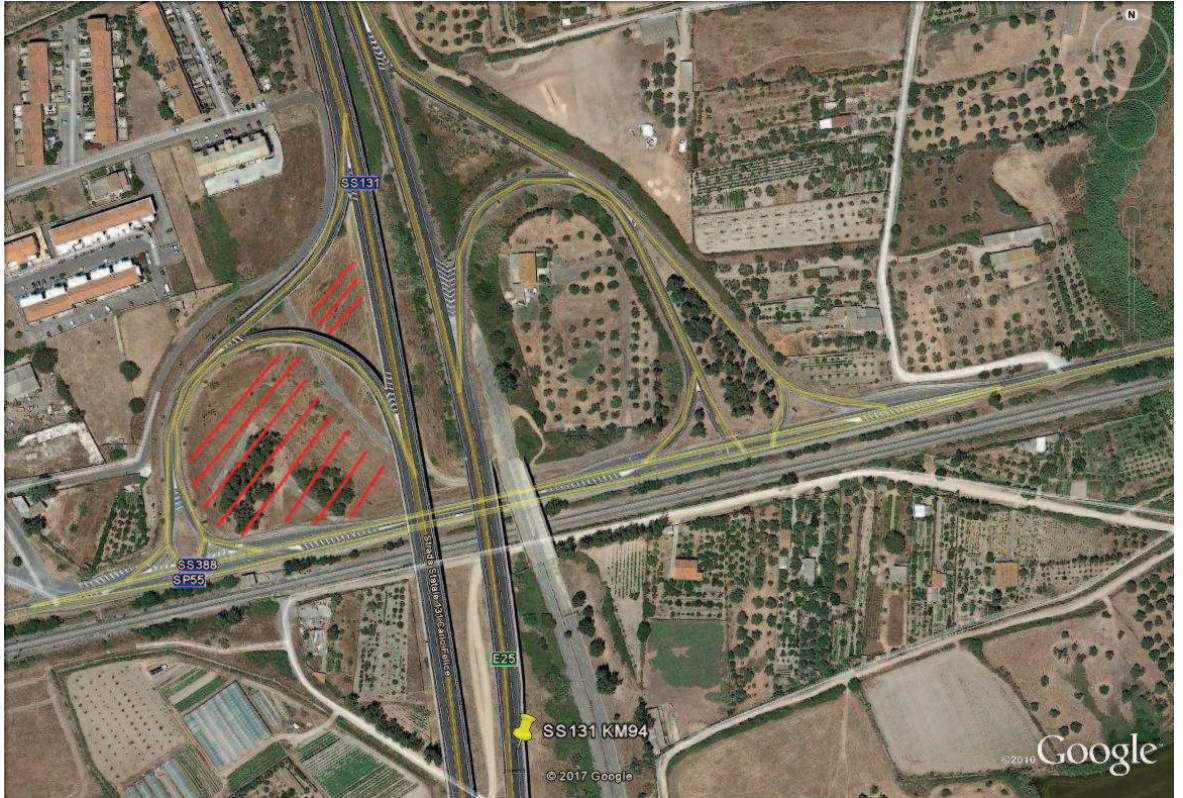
Planimetria aerofotogrammetrica dell'area di cantiere nei pressi di Sili
